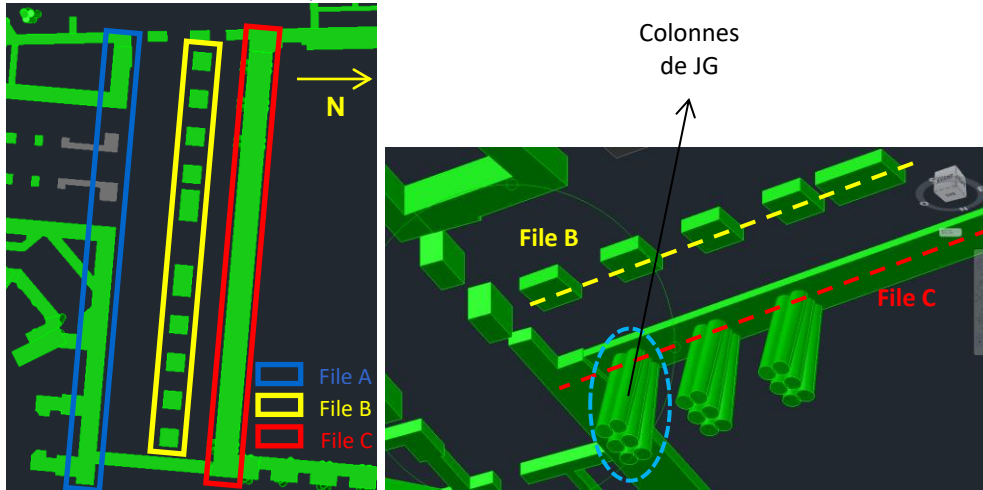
A gauche : vue en plan des files de fondations du BIN – à droite : vue de dessous du système de fondations des appuis de la file C – côté Palais d'Antin
